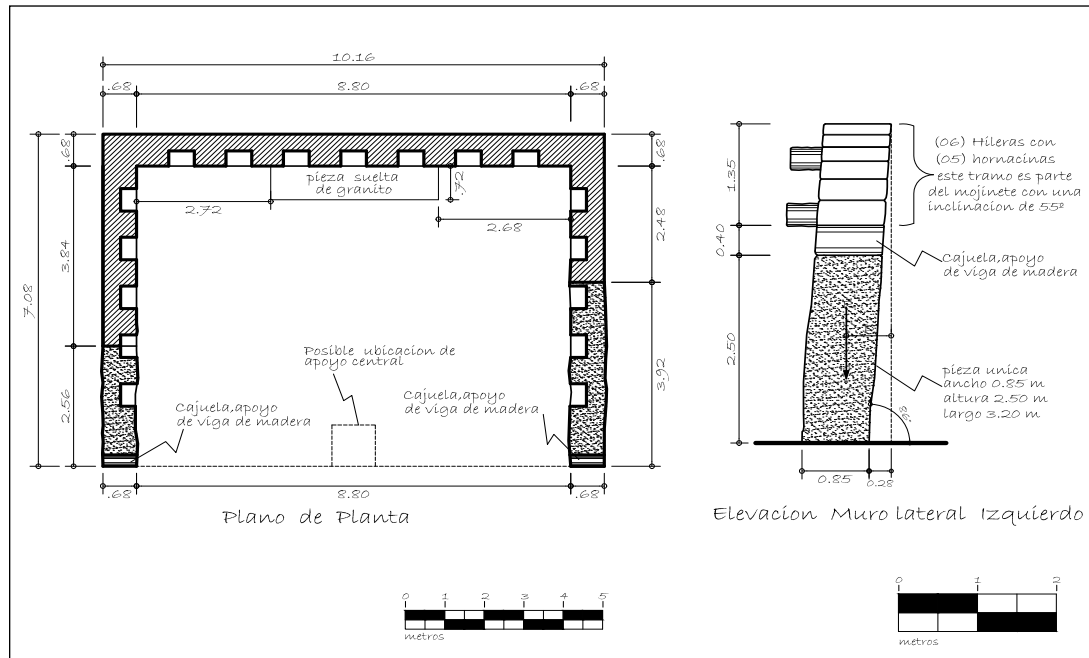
Templo Principal. Plano de planta y elevación del muro lateral izquierdo.
